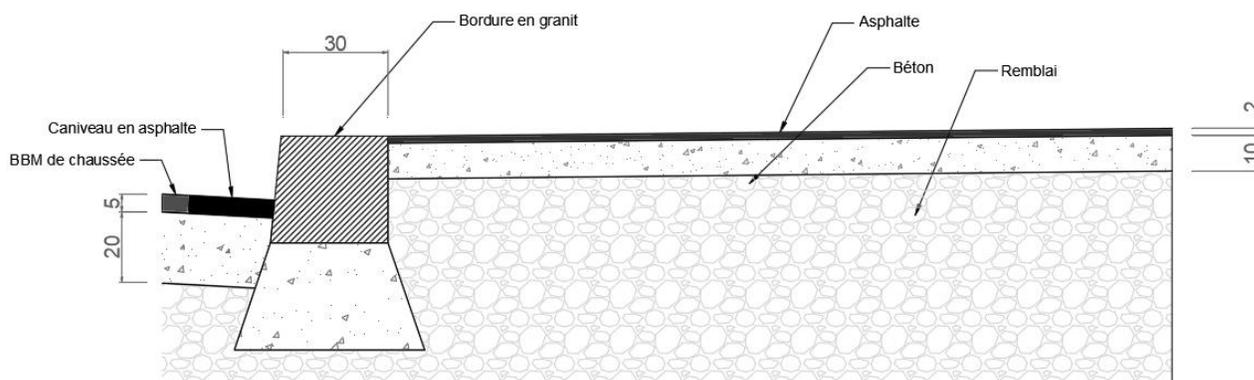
Coupe d'un trottoir avec amorce de chaussée (Jacques BAVAY)
